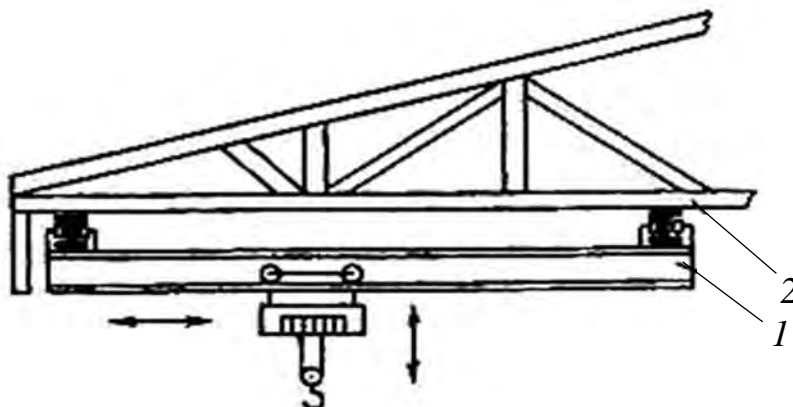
Схема подвесной кран-балки: 1 – подвесная кран-балка; 2 – металлоконструкция здания
